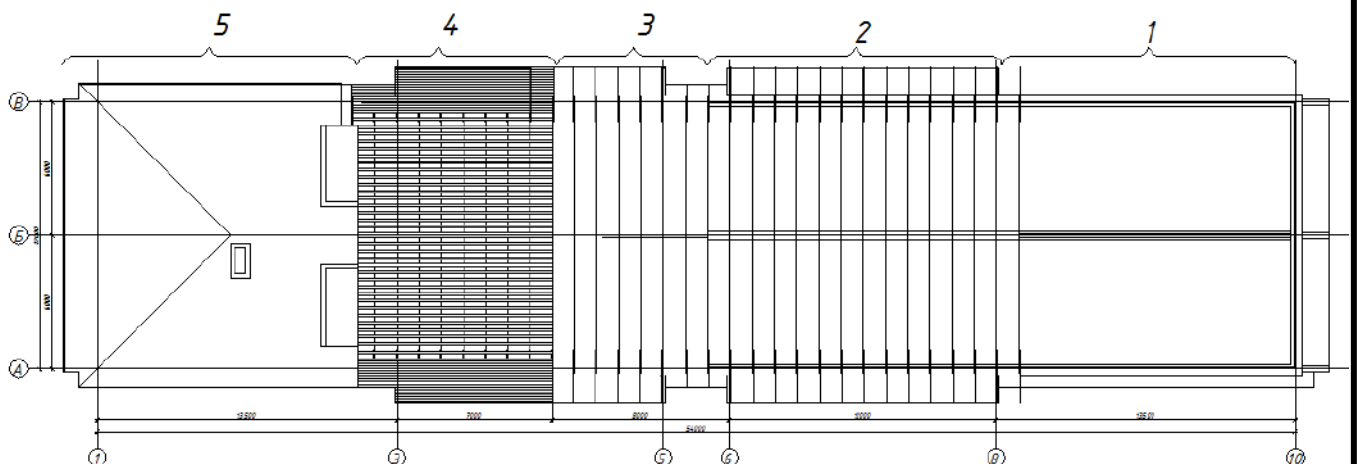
Схема организации работ по устройству стропильной системы из бруса с обрешеткой из досок
